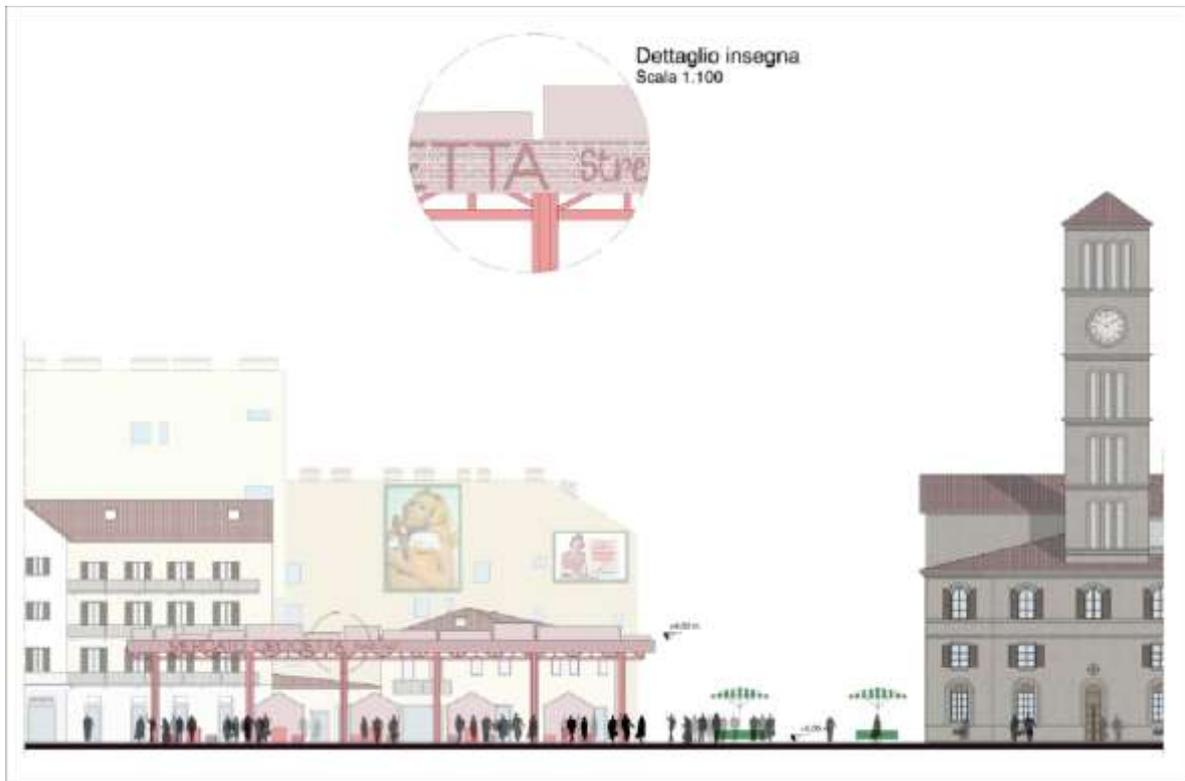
Prospetto di Largo Cassini con la nuova area street food.
